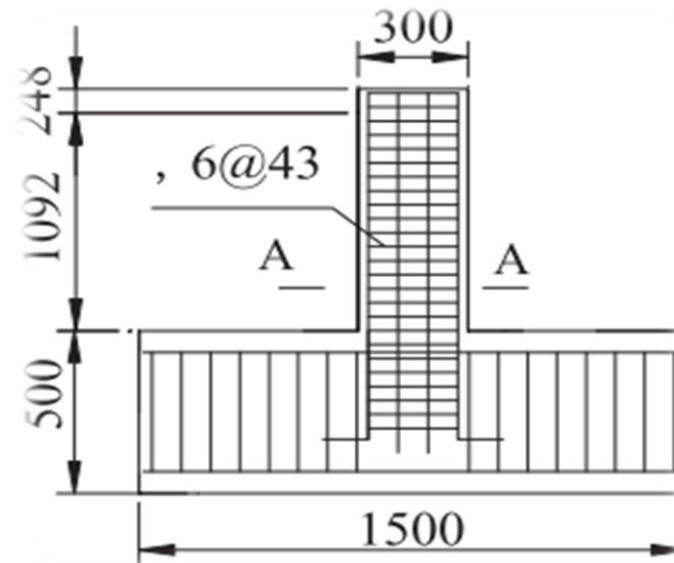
Dimensionnement et géométrie du poteau en béton armé en (mm).
